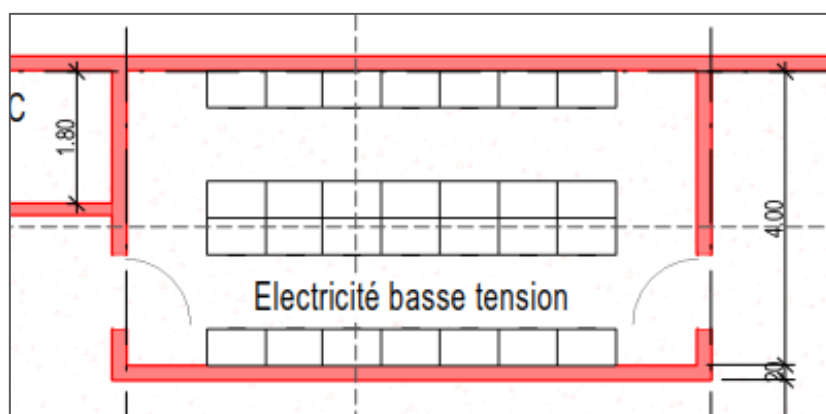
Plan d'installation des locaux électriques (basse tension)
